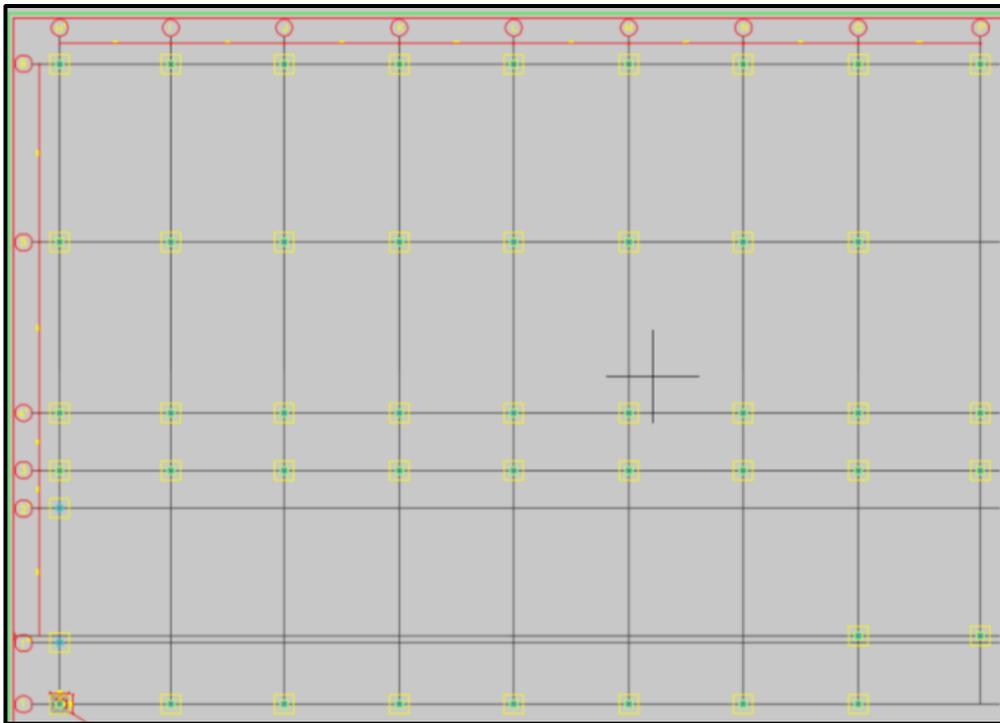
Planta de cimentación – Estructura No. 2 Bloque Aulas y Talleres
